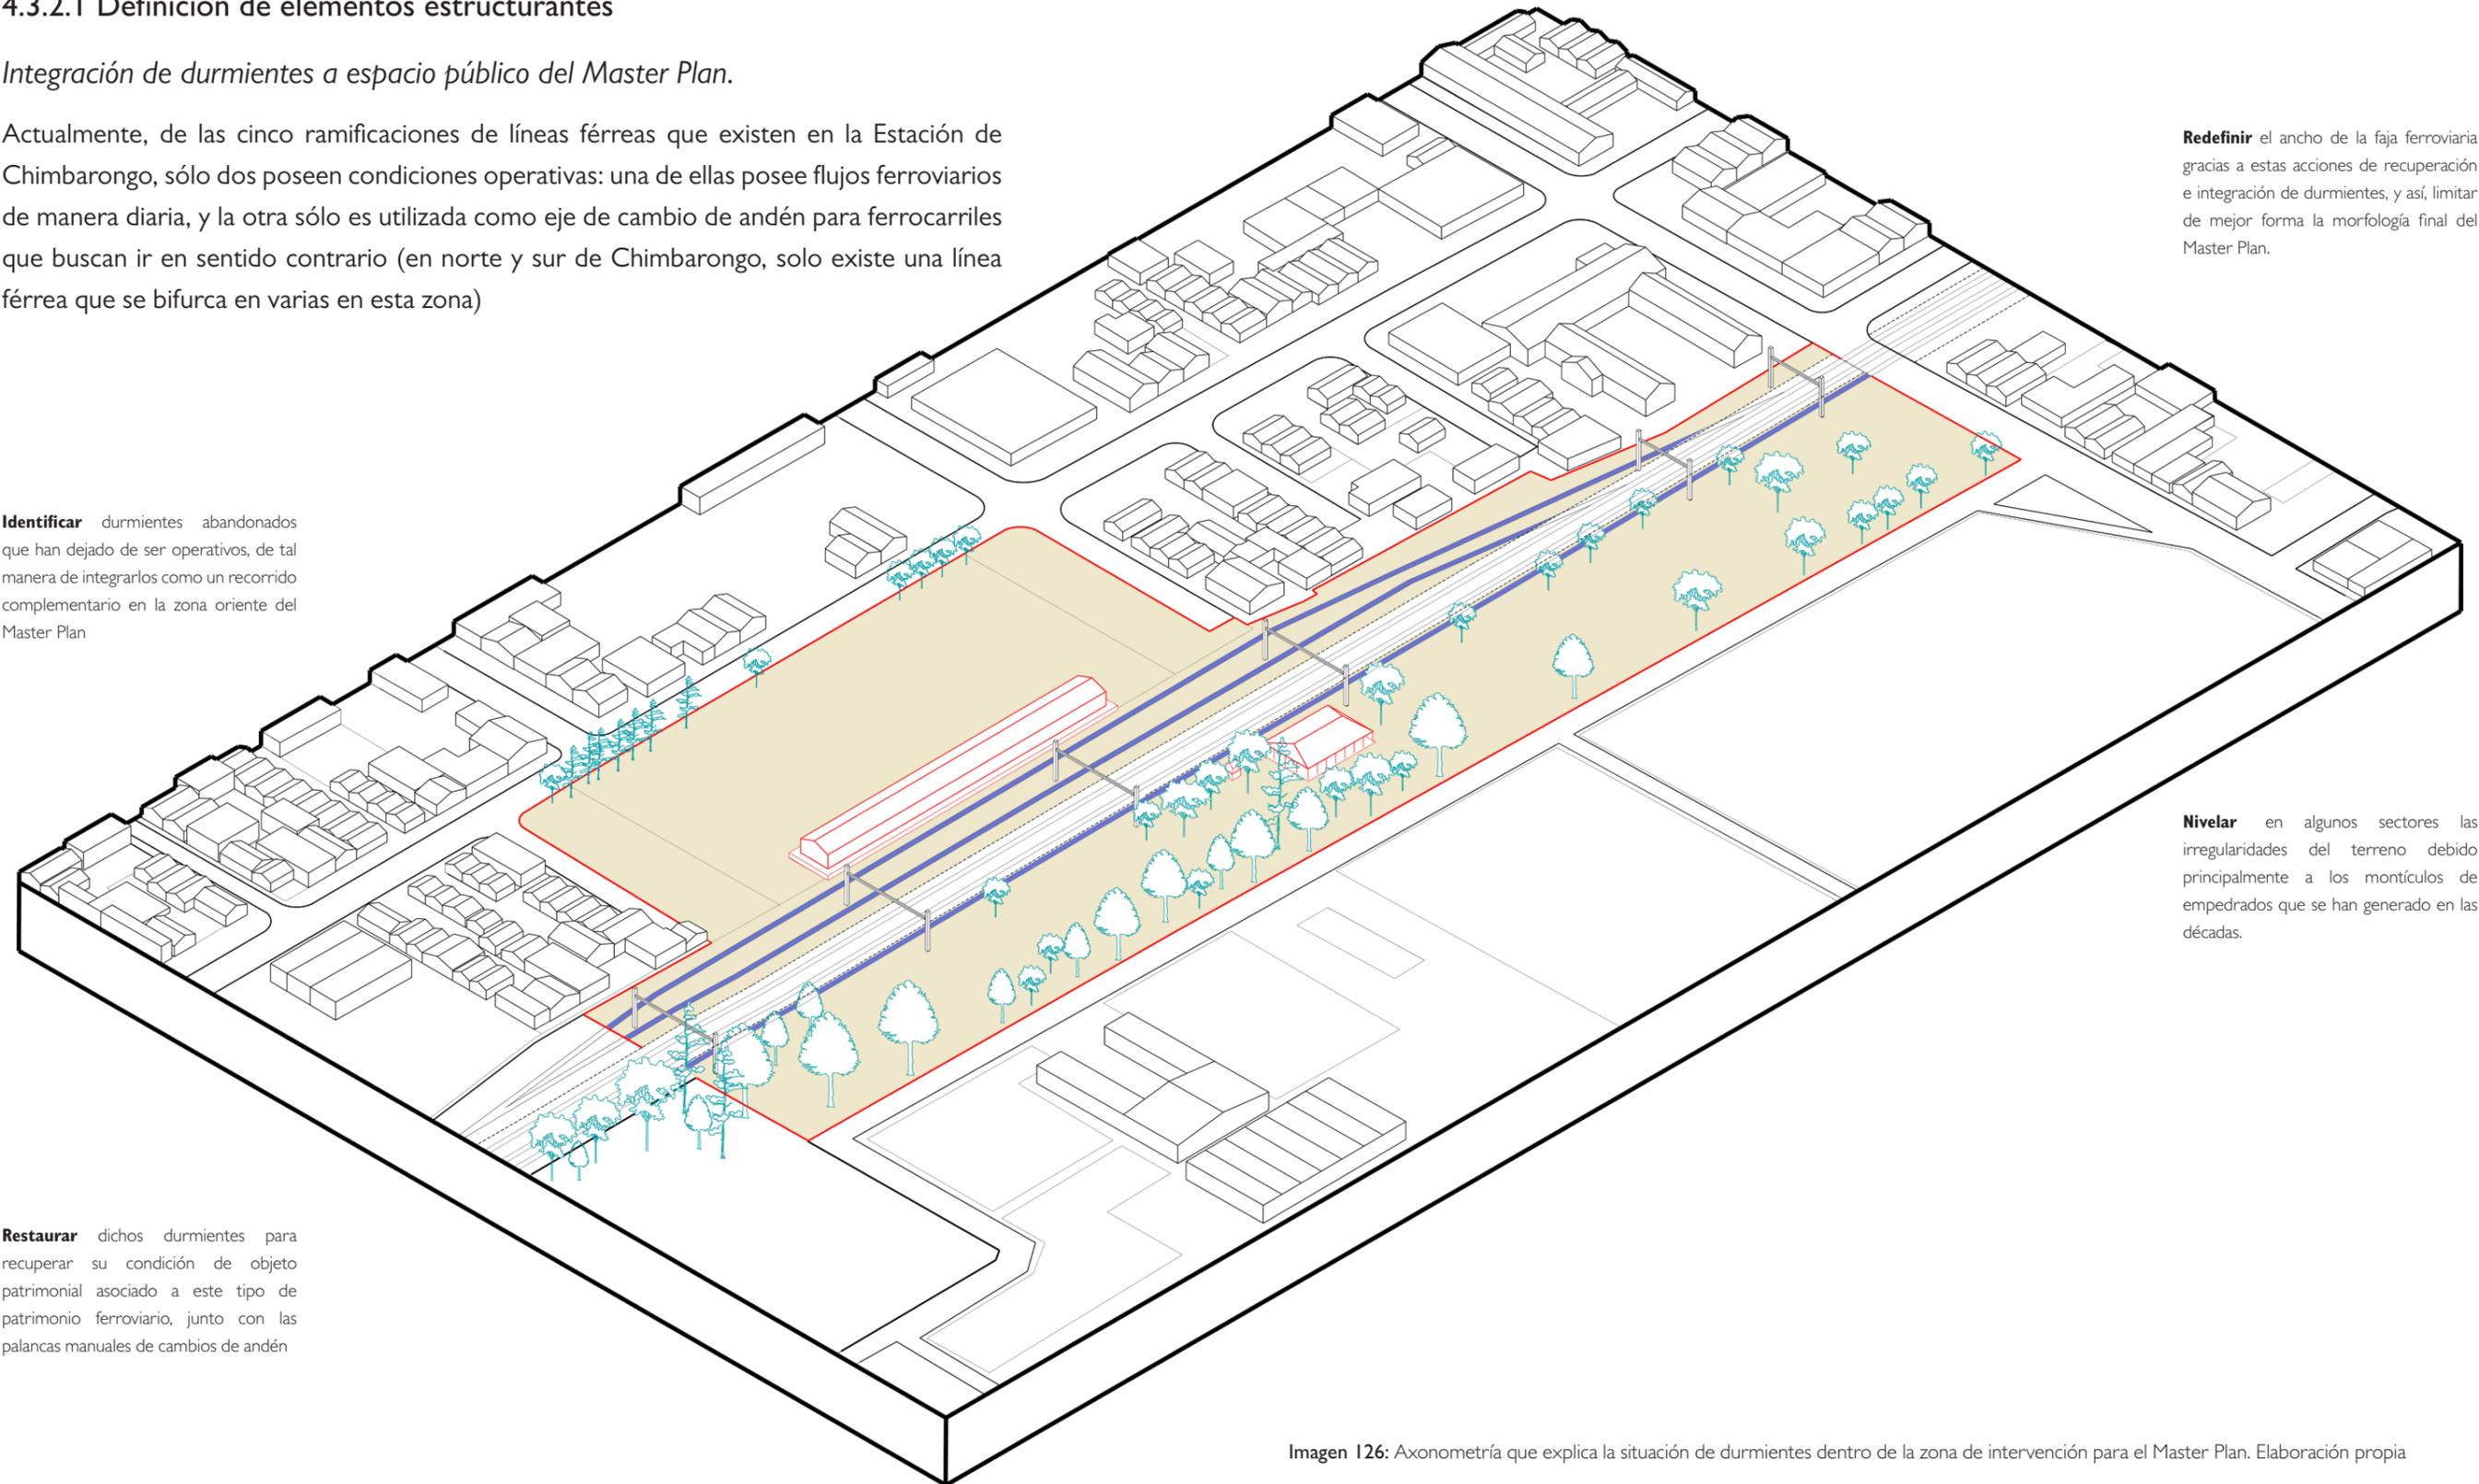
Axonometría que explica la situación de durmientes dentro de la zona de intervención para el Master Plan. Elaboración propia
